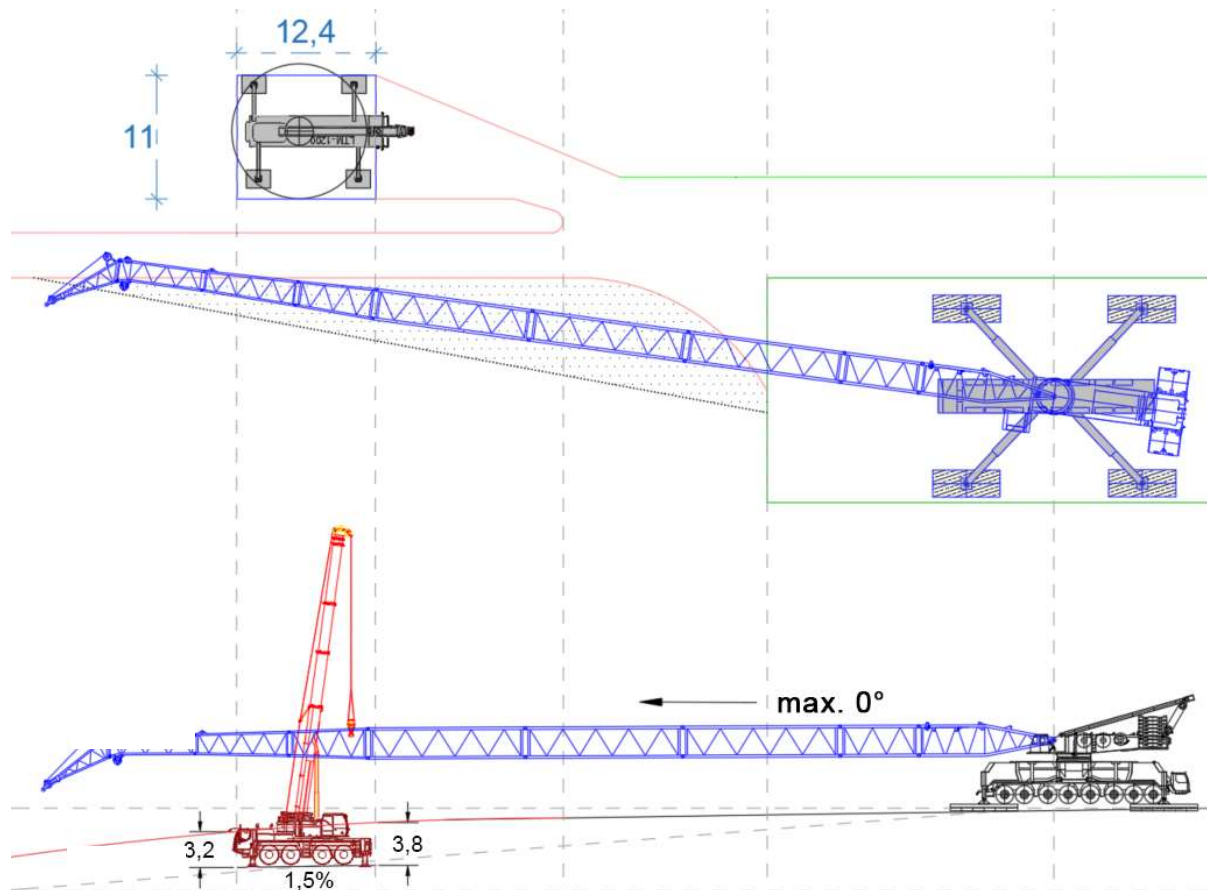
Beispiel für eine befestigte Fläche für den Hilfskran q2 in hügeligem Gelände.
